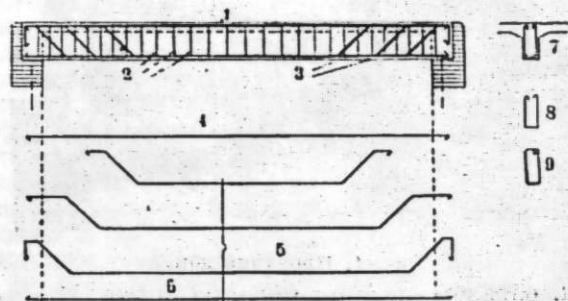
1 — монтажное железо, 2 — хомуты, 3 — рабочая арматура, 4 — два монтажных стержня, 5 — рабочие стержни, 6 — прямые стержни (не менее двух), 7 — поперечное сечение, 8, 9 — формы хомутов (8 — открытая, 9 — замкнутая).
